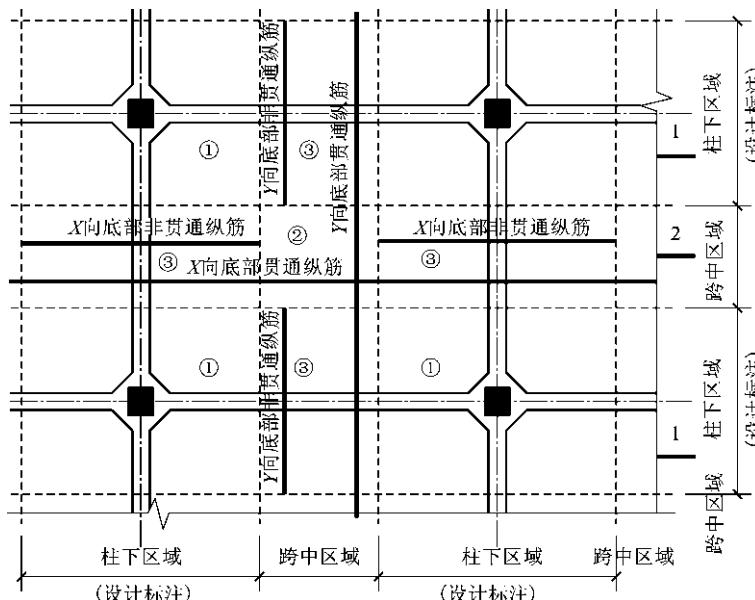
梁板式筏形基础基础平板 (LPB) 底部钢筋平面布置图
